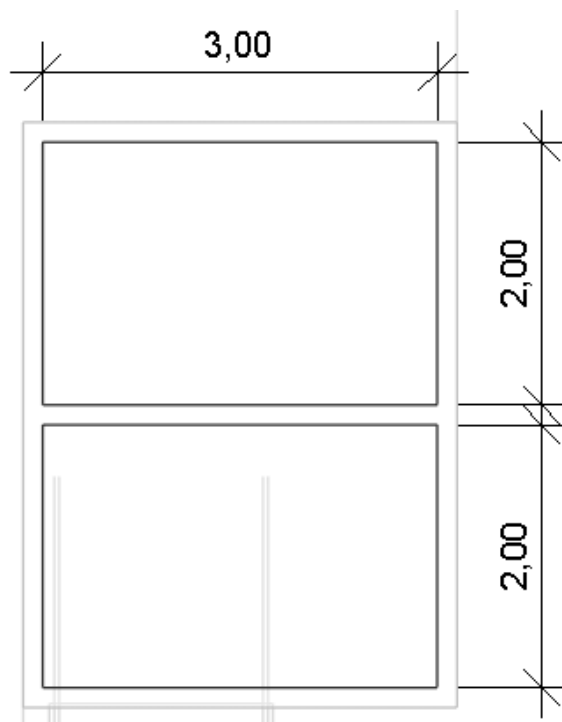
Reservatório Superior Bloco 03 – Vista Longitudinal
